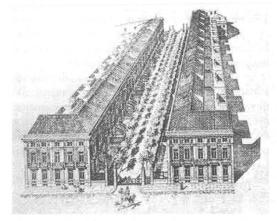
Proyecto del Pasaje de Hoteles entre las calles de Jorge Juan y Alcalá. (Anónimo 1898)
